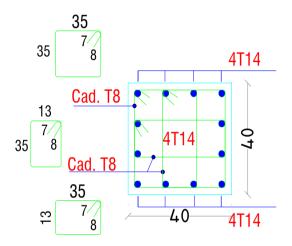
coupe Ferraillage des poteaux (40×40) cm².
